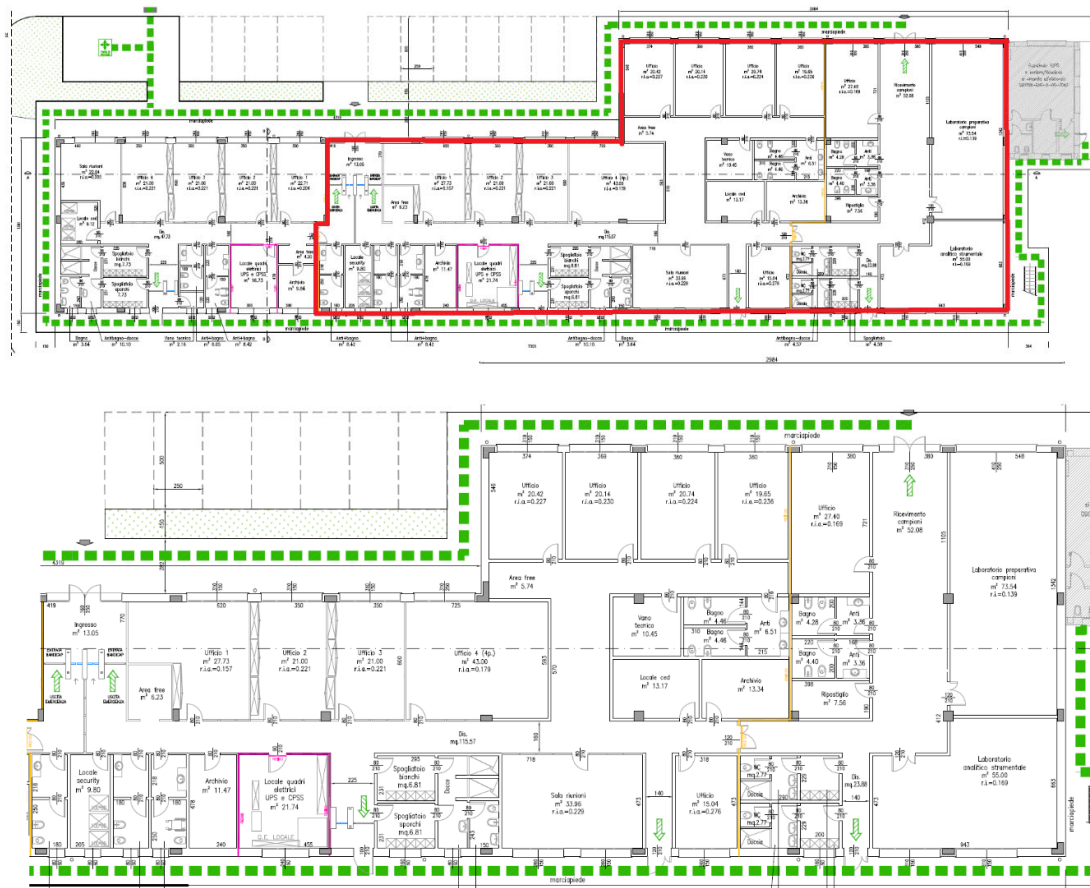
Palazzina uffici, parte Eni Rewind (in rosso) – estratto dal documento progettuale 090026-ENG-D-DG-3032 - Palazzina uffici/laboratorio tecnologico: pianta fondazioni, pianta piano terra, pianta coperture, sezioni e prospetti - scala 1:100
